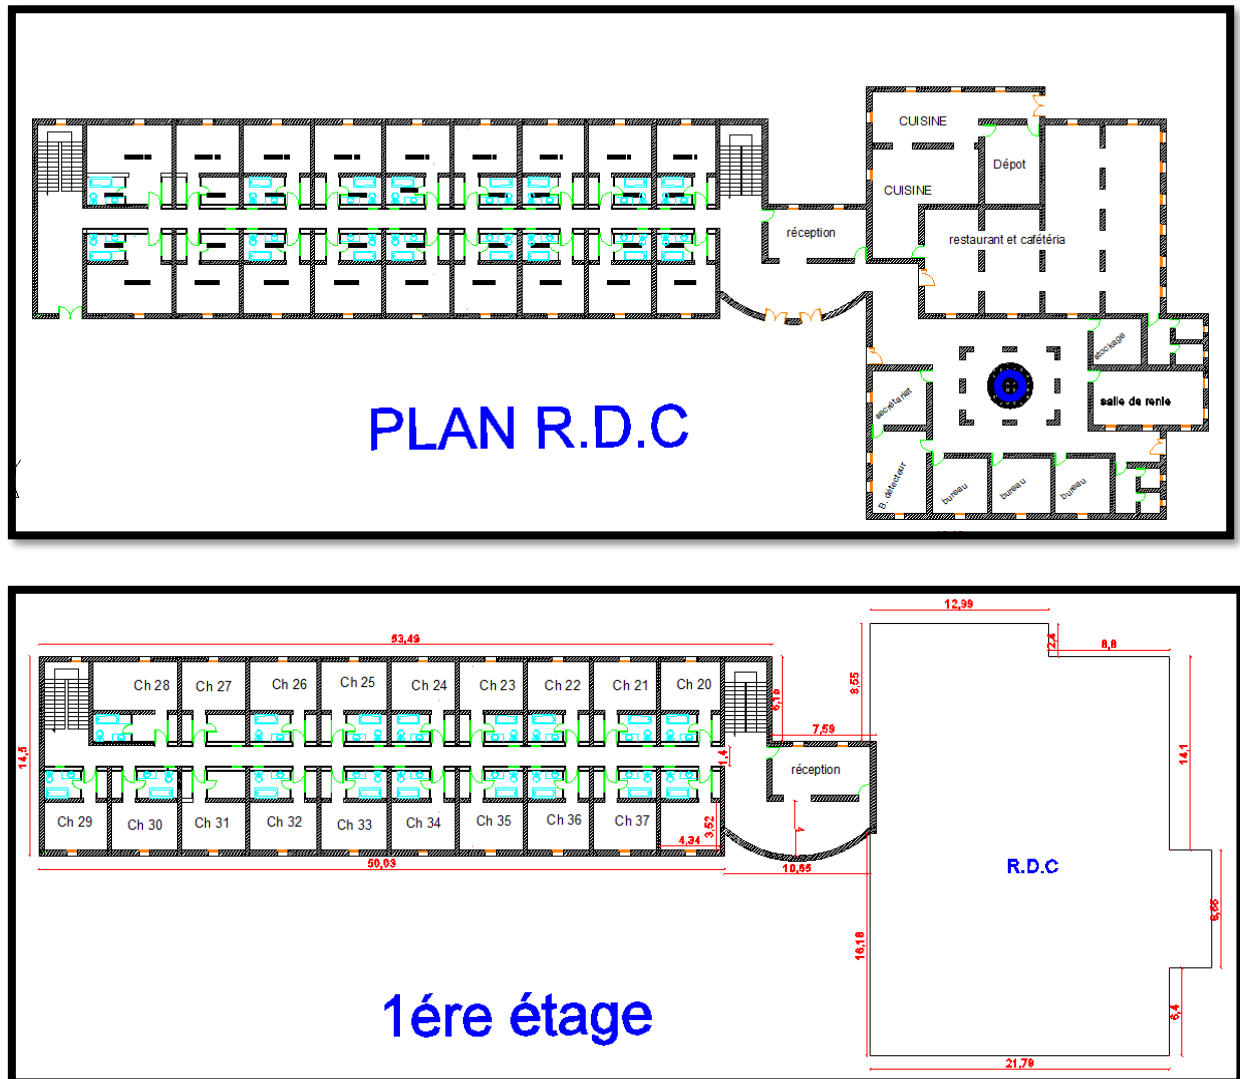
Plans d'Hôtel. (Source : par l'auteur)
